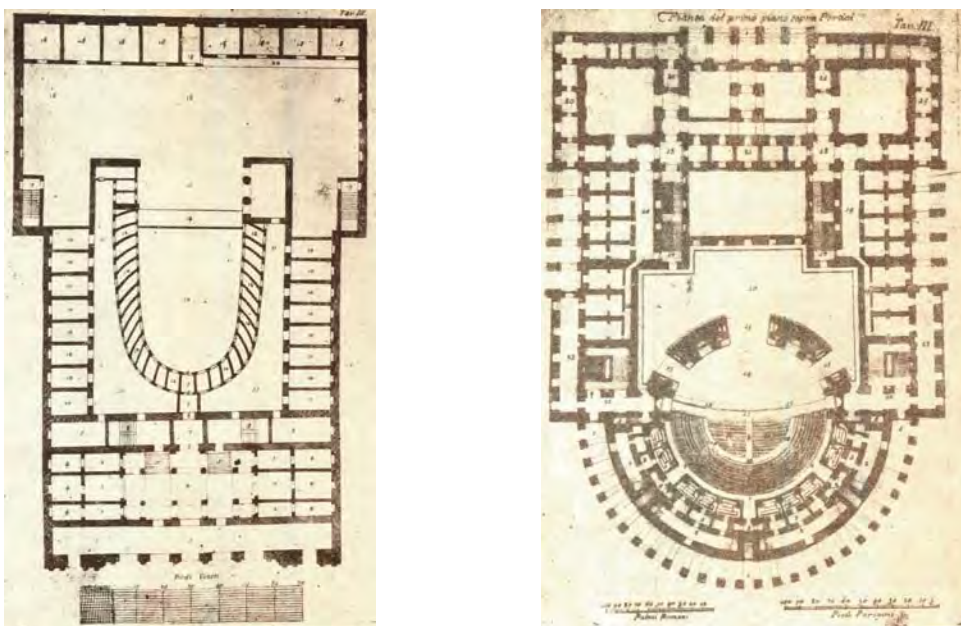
Pianta proposta dal Riccati e dal Milizia. ©Donghi, D.
